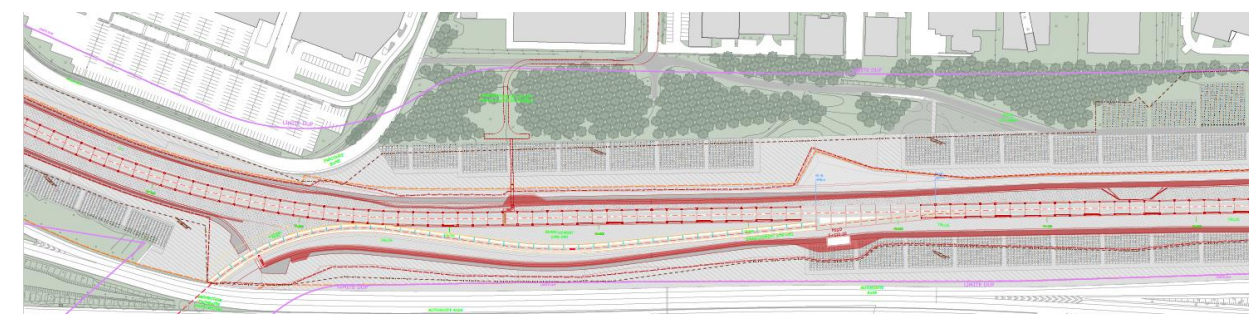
Vue en plan de l’ouvrage en terre entre les deux franchissements A1/A3 et RD40
